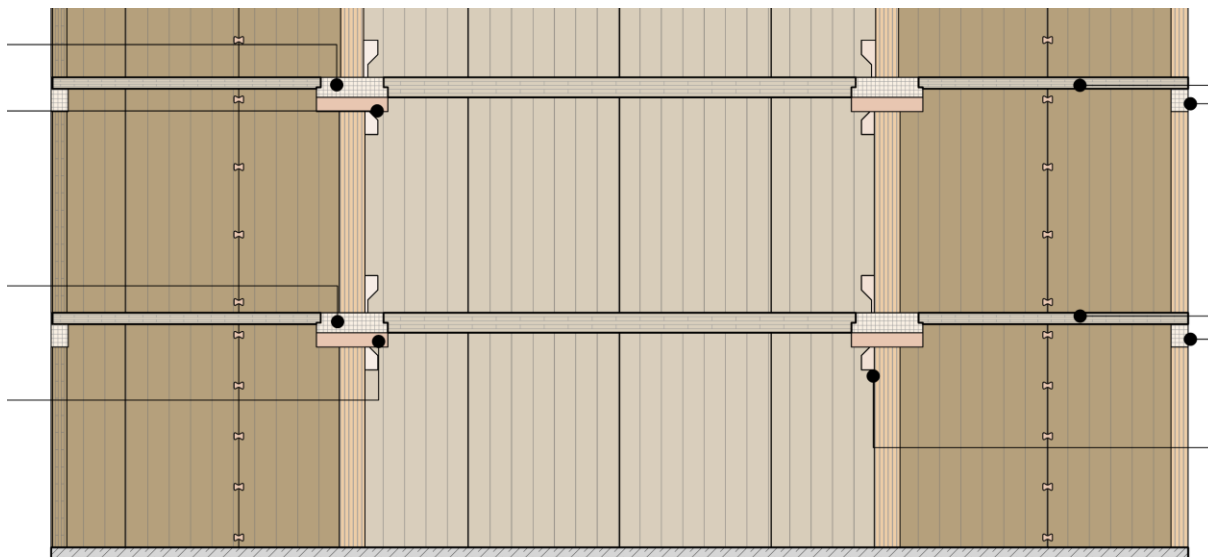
Ausschnitt Gebäudeschnitt Konzept 2
